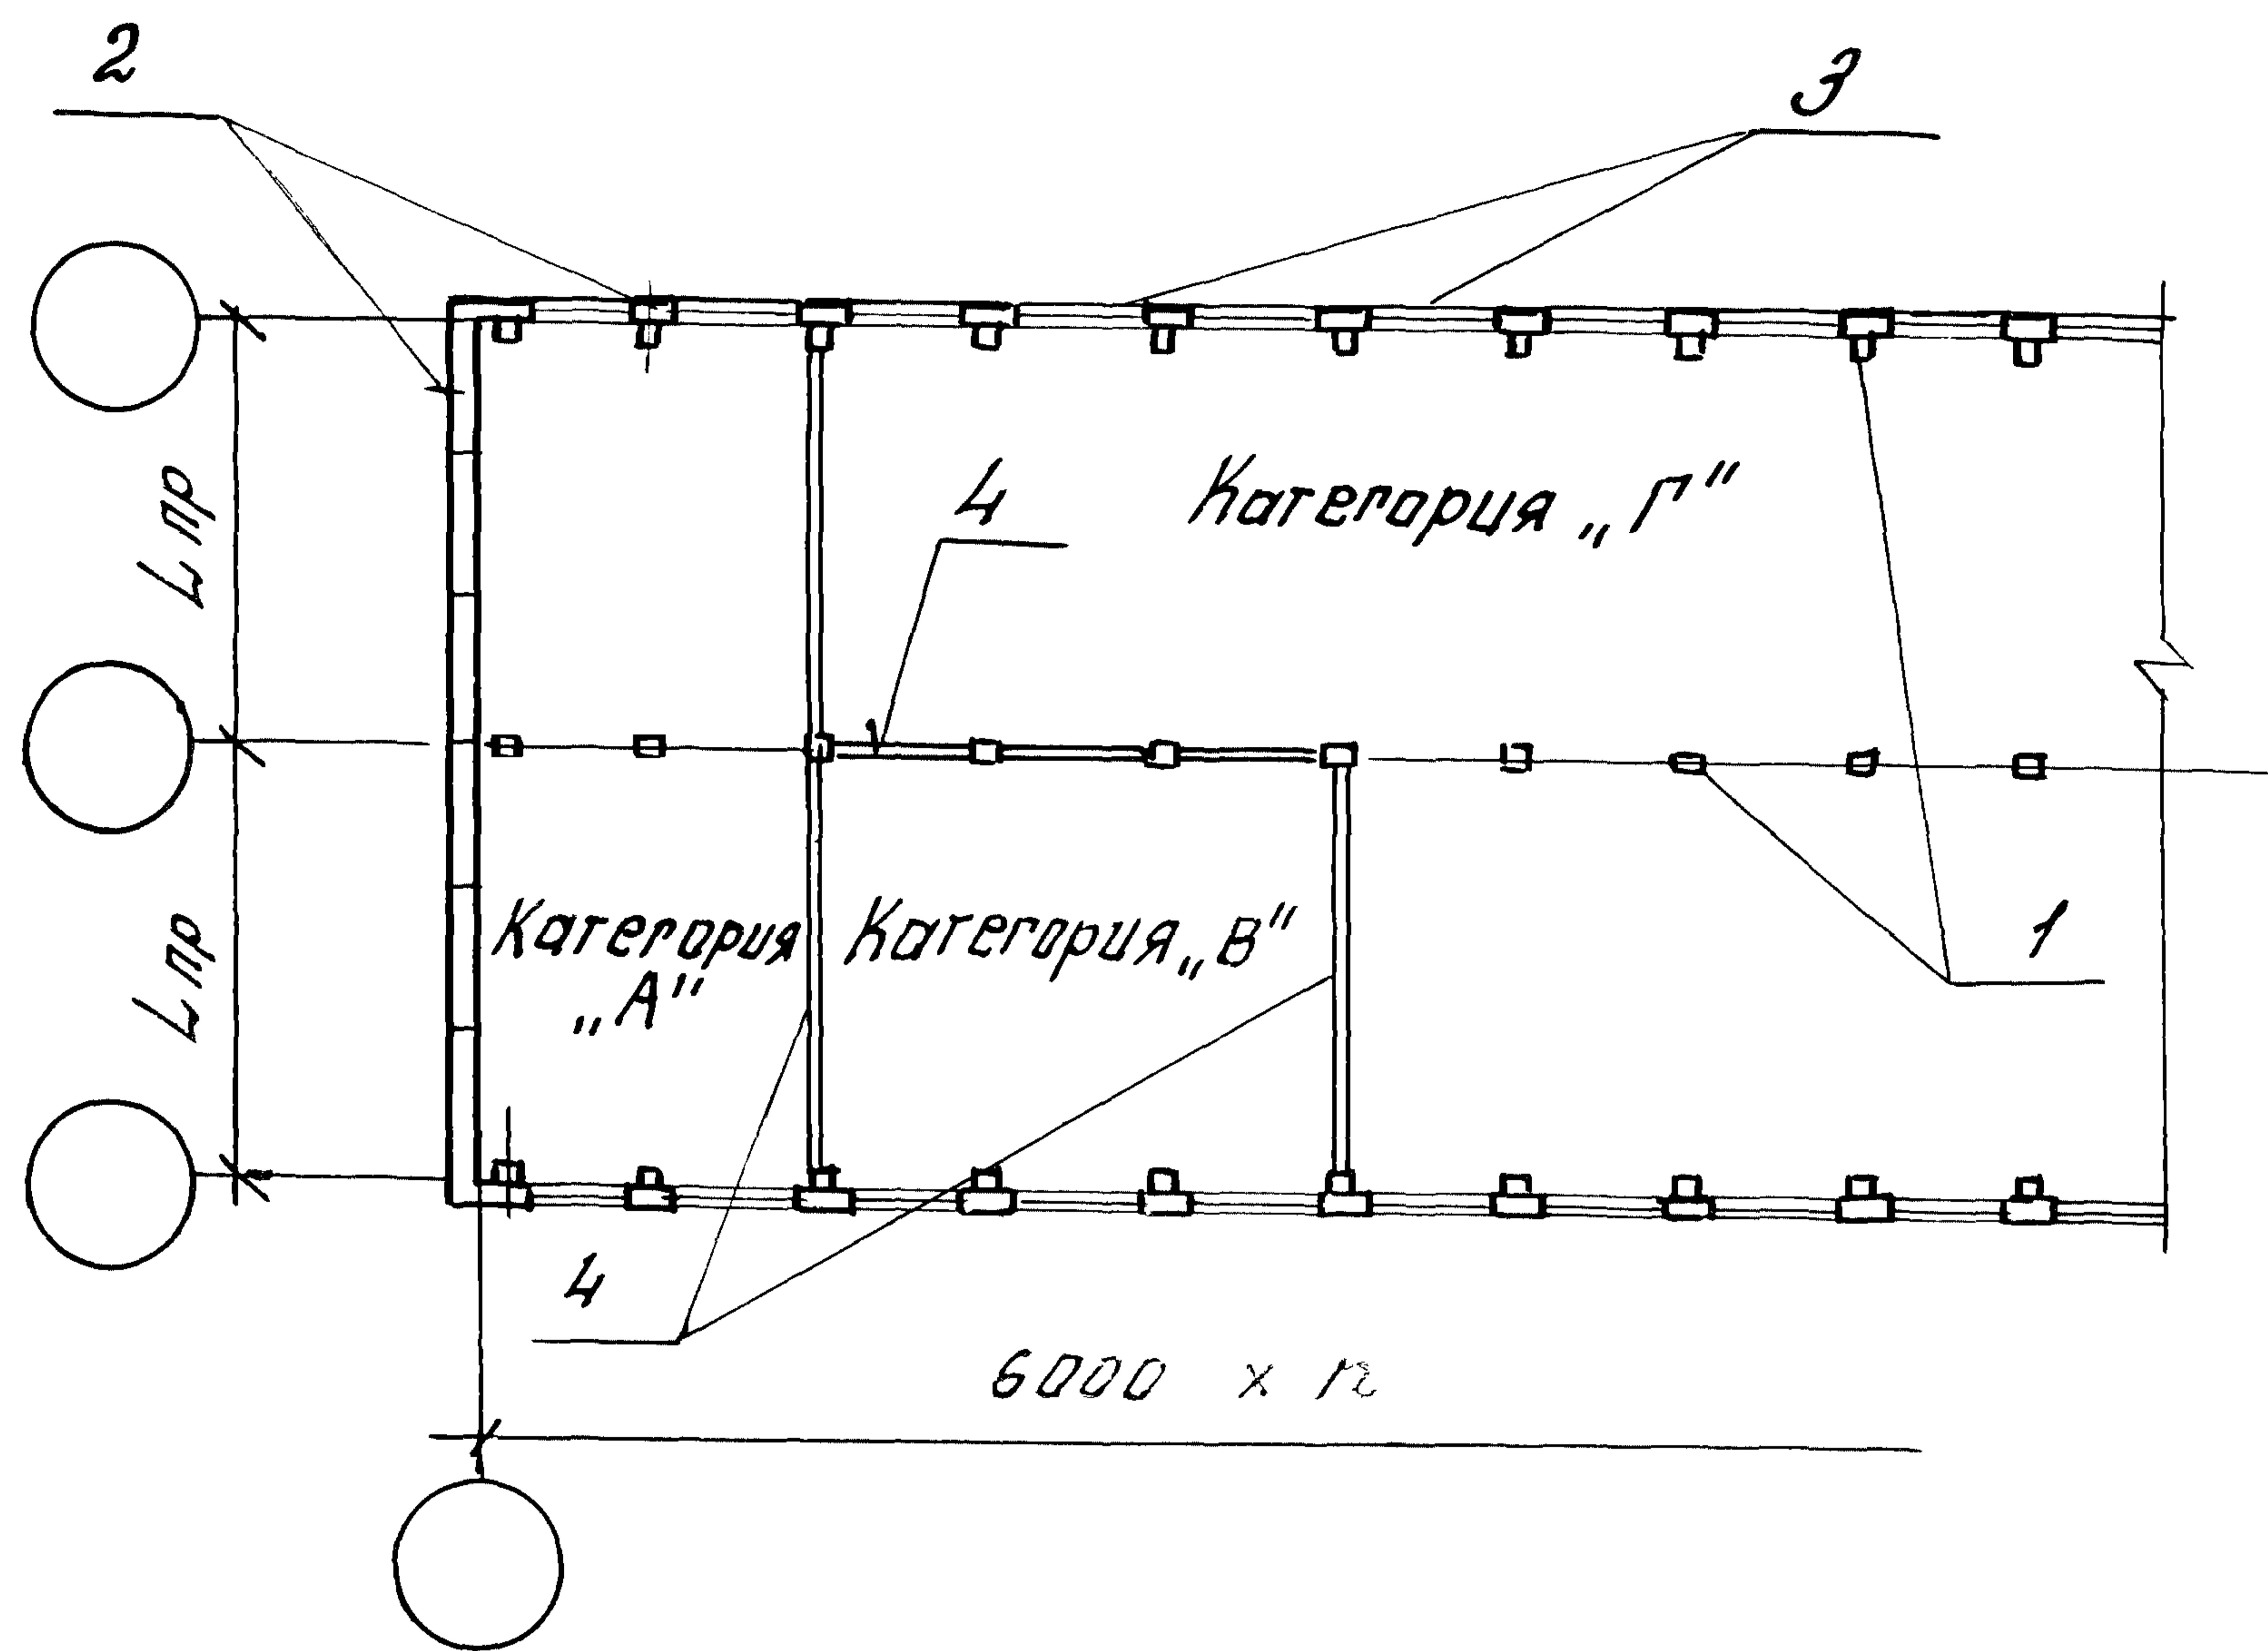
Пример расположения противопожарных перегородок в плане здания со стенами и покрытием из негорючих материалов
